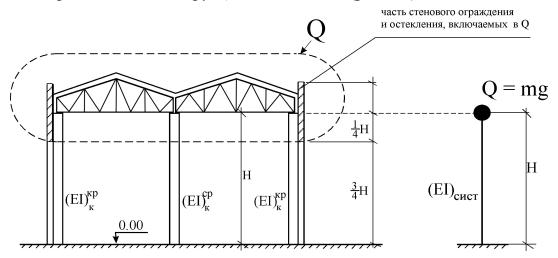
Формирование динамической расчетной схемы при шарнирном сопряжении стропильной конструкции с колоннами.
